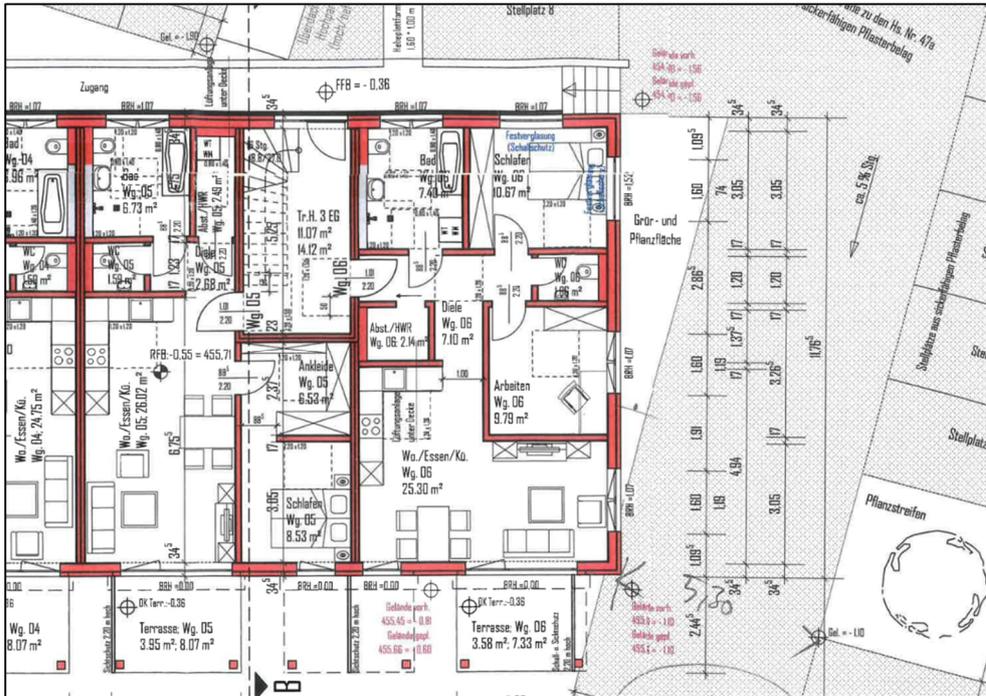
Auszug aus dem Grundriss für das EG / OG des Mehrfamilienhauses /26/
